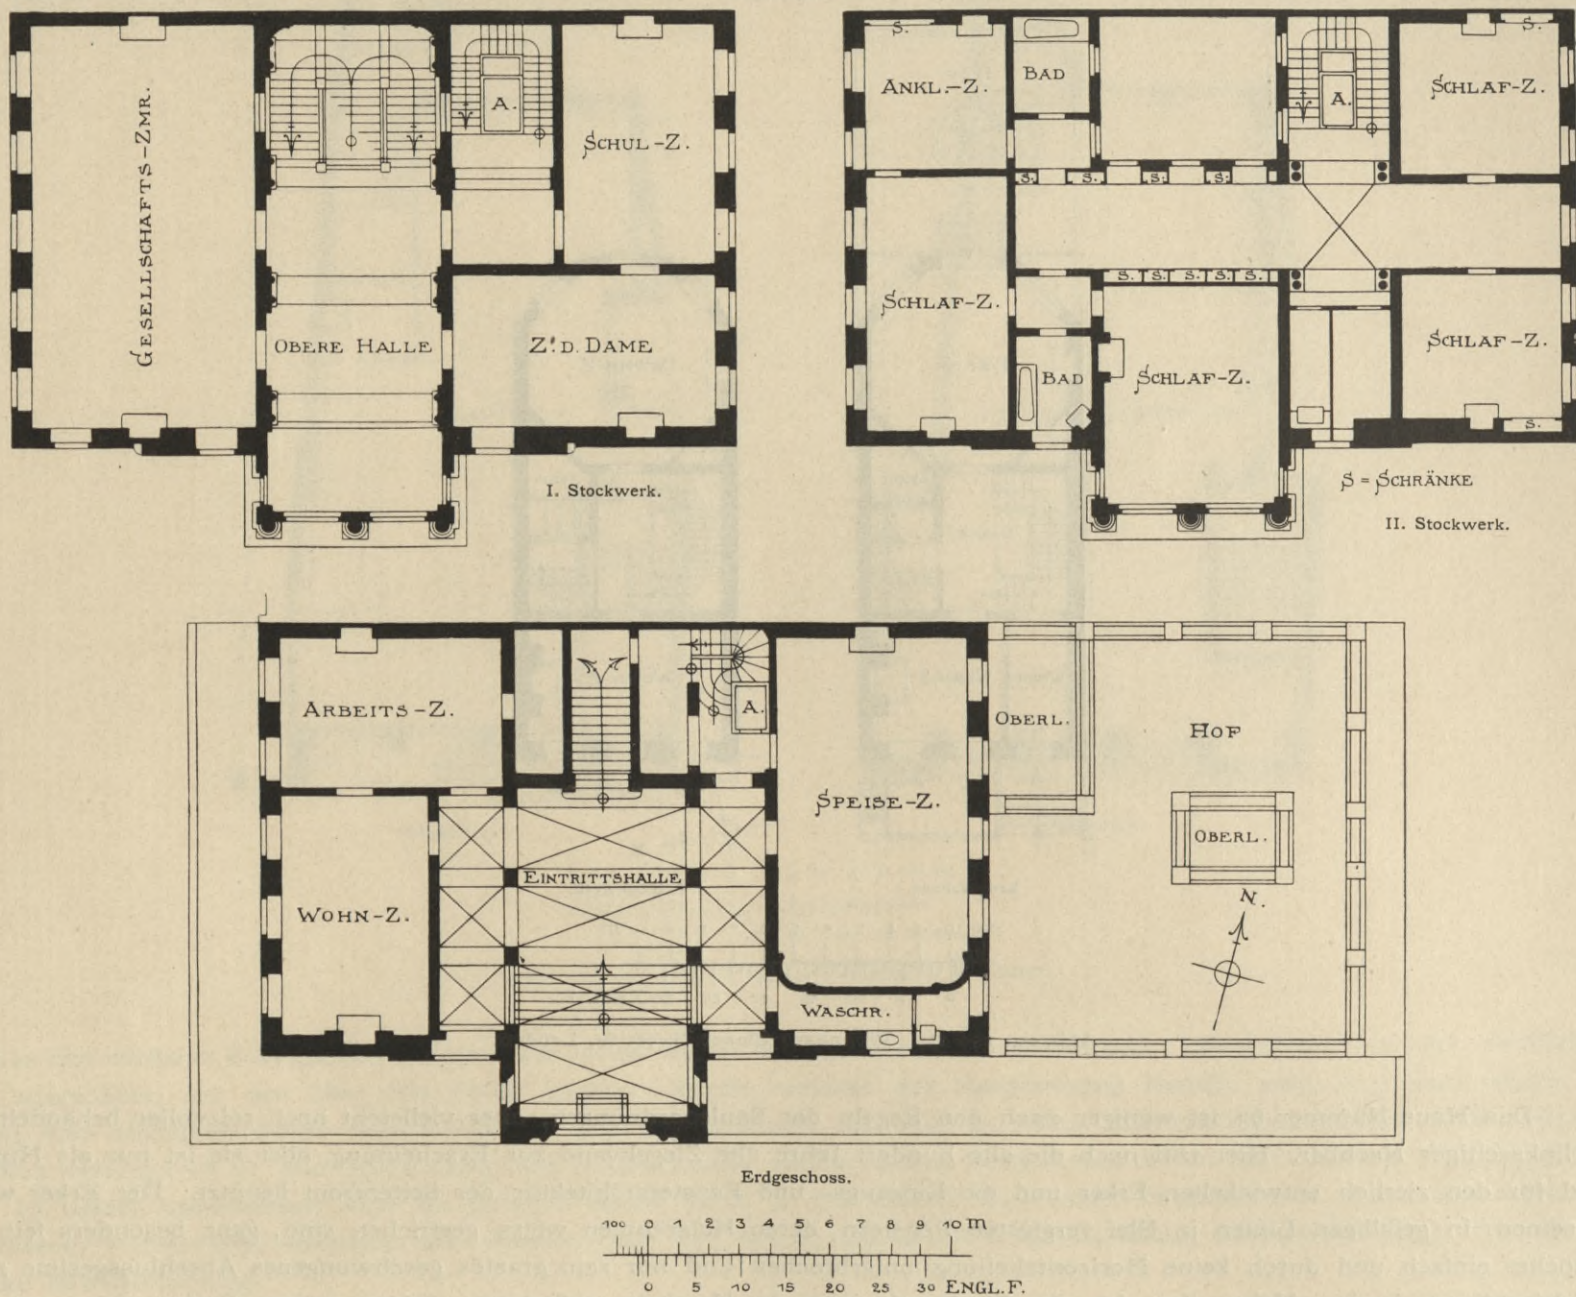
bis 134. Wohnhaus Mount Street 54, London.
